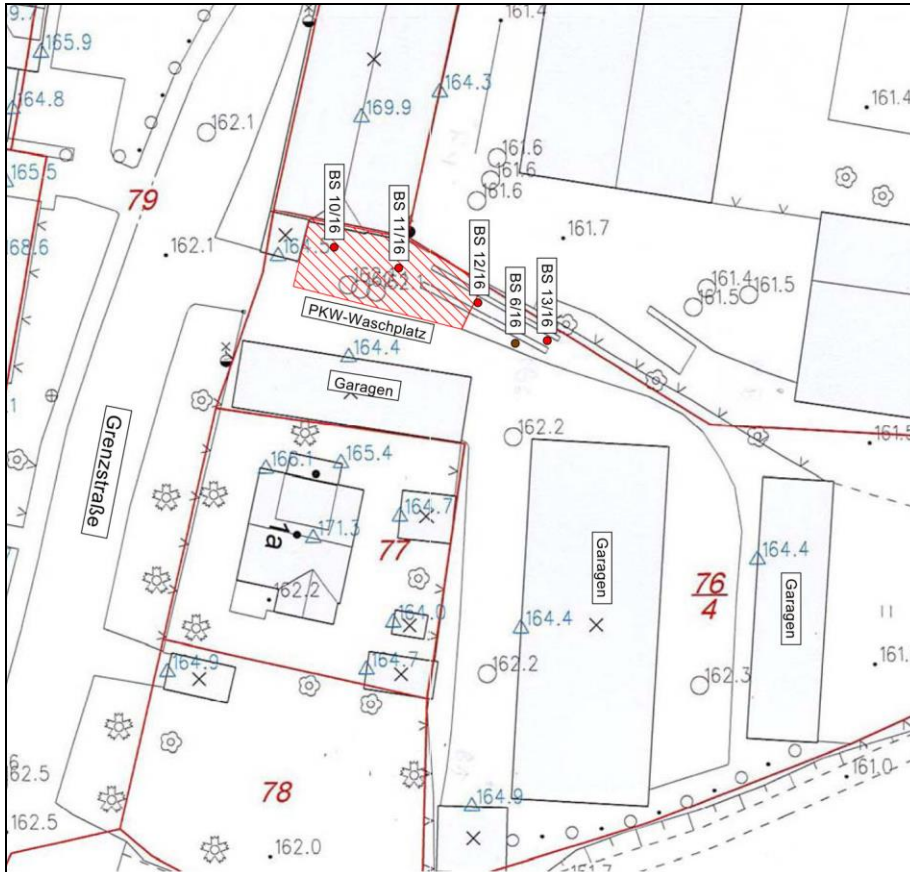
Lage- und Aufschlussplan (Quelle: Geotechnische Stellungnahme Jena-Burgau, Altes Gut - Ergänzende Altlastenuntersuchung im Bereich PKW-Waschplatz & Rampe, BEB Jena Consult GmbH, 07.12.2016)
